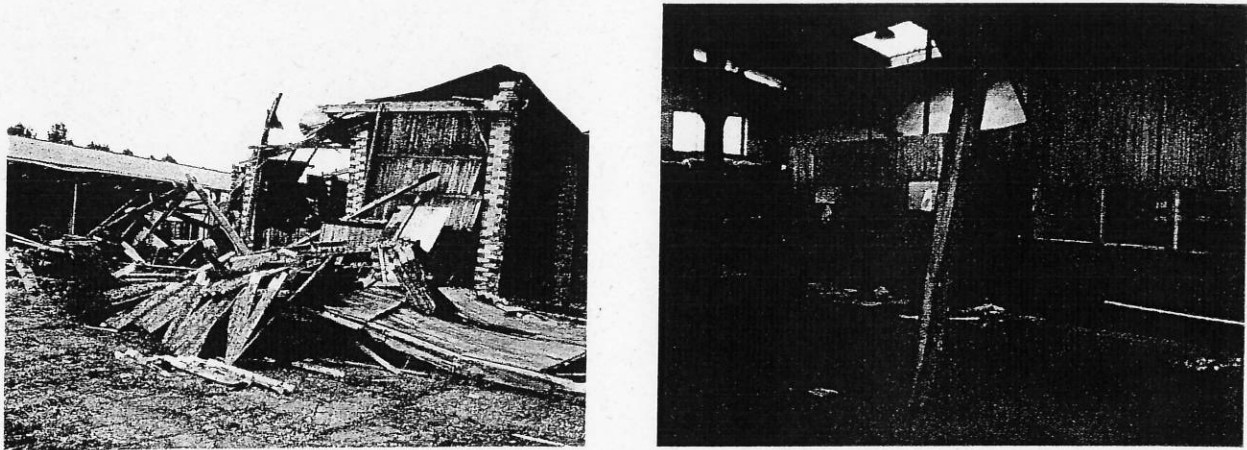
Bâtiment effondré suite Tempête Klaus et Poteau arraché suite à la vente aux enchères
